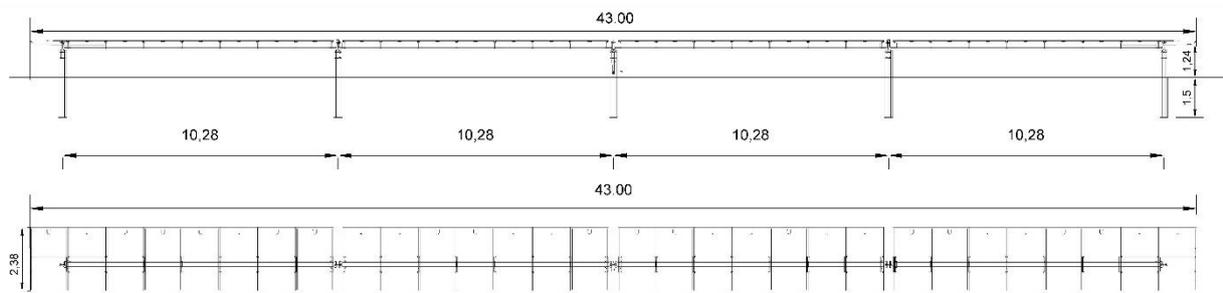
Prospetto frontale e vista in pianta delle strutture (30 moduli) ad inclinazione 0°
